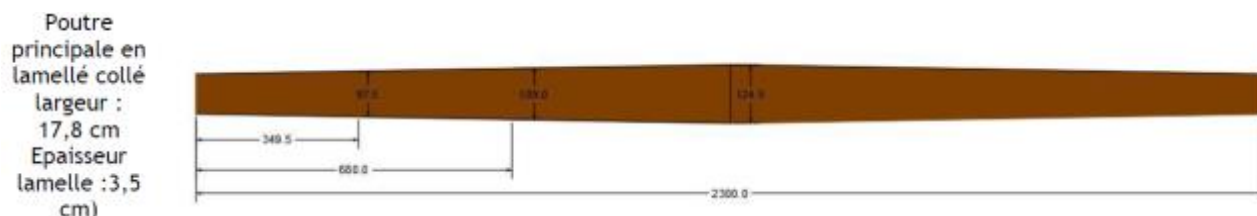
Caractéristiques des poutres principales (poutres 1) de plus grande portée
